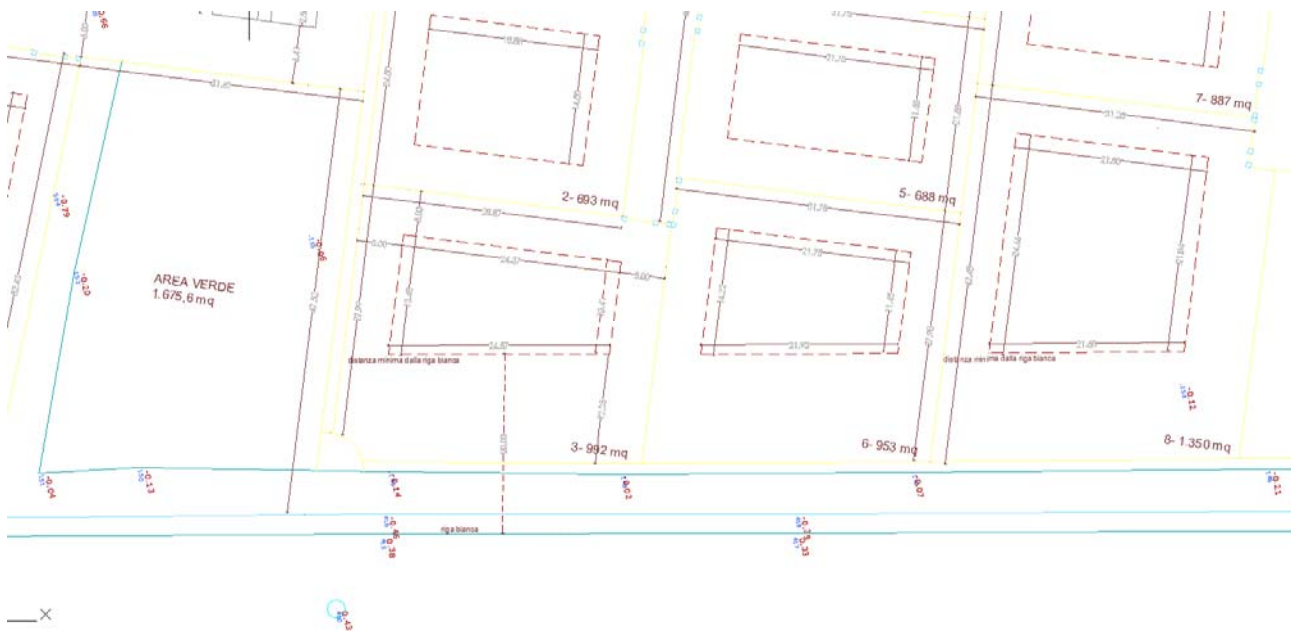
Particolare della planimetria di progetto con indicazione distanza da margine stradale.
